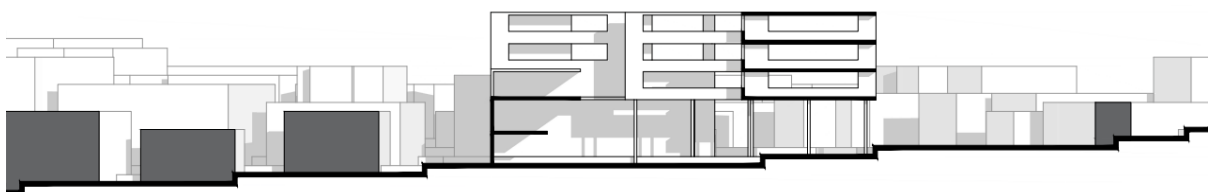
Sección C-C' - Anteproyecto 01. Elaboración propia.
